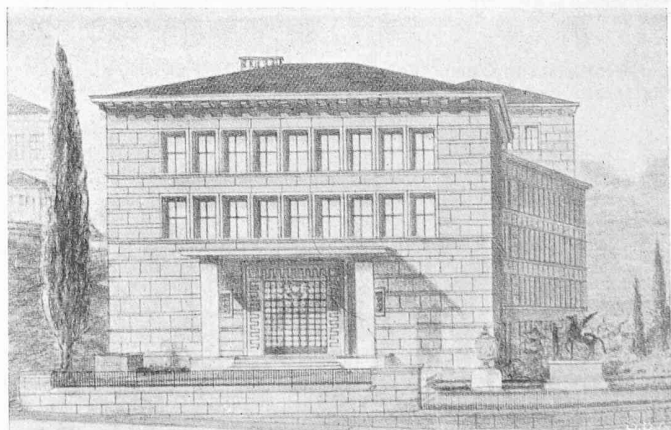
Façade sud du projet de bâtiment de la Cité, par A. LAVERRIERE, arch. Echelle 1 : 400
